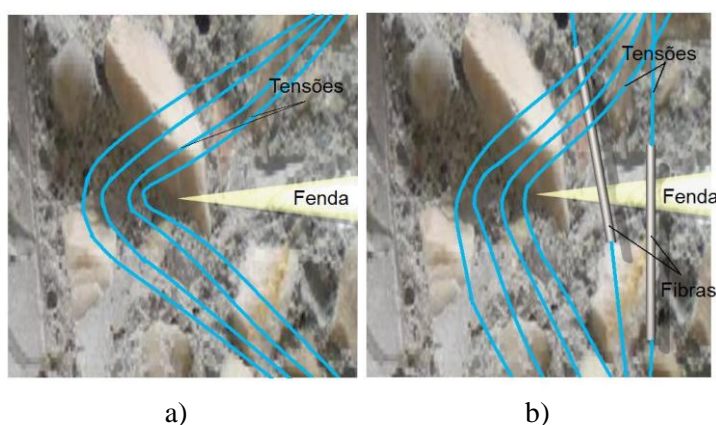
Esquematização do fluxo das tensões no betão. a) sem fibras metálicas; b) com fibras metálicas (Adaptado de Vitt, 2011).
